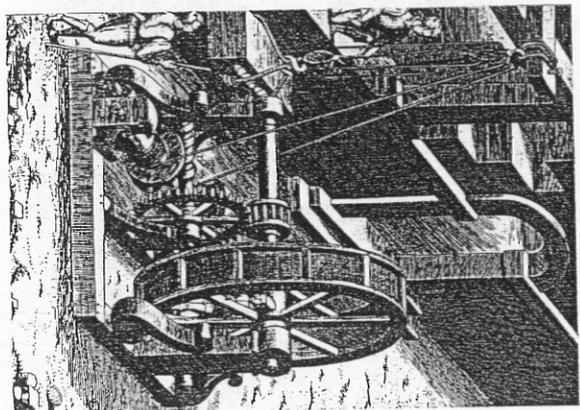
Macchina per sollevare pietre da costruzione (1588).
